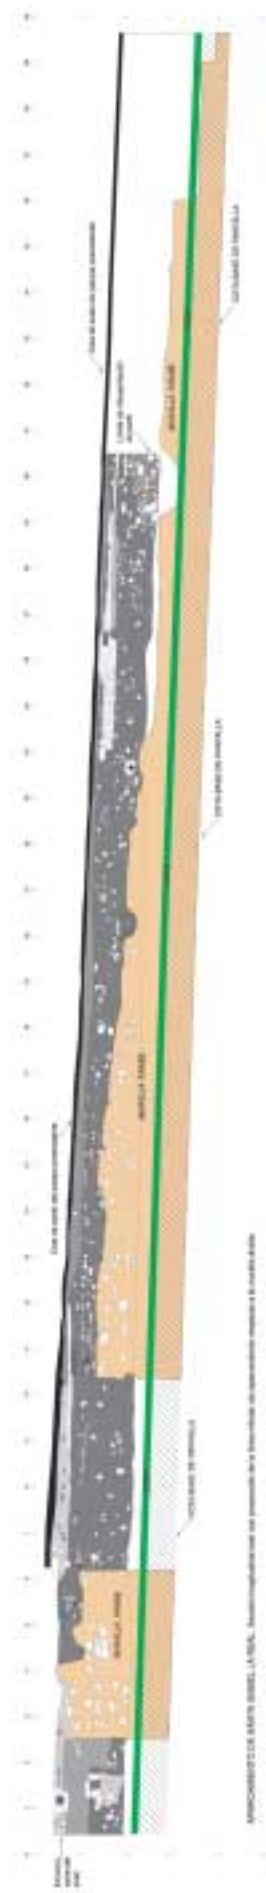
Perfil del aparcamiento proyectado y alzado superior de la muralla.
